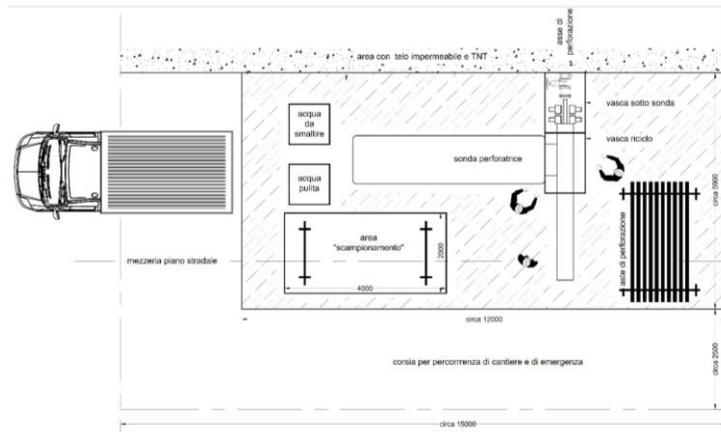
schema di cantierizzazione sonda all'interno del traforo
